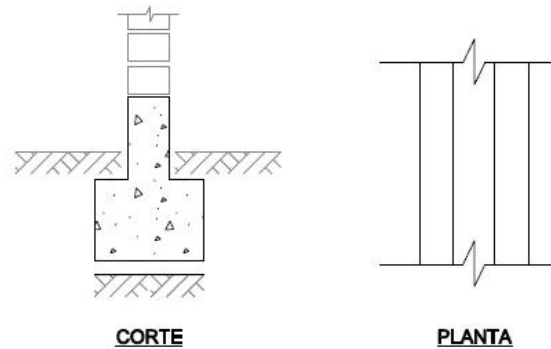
Vista en corte y planta de una zapata para un muro (Peck, 1988)
